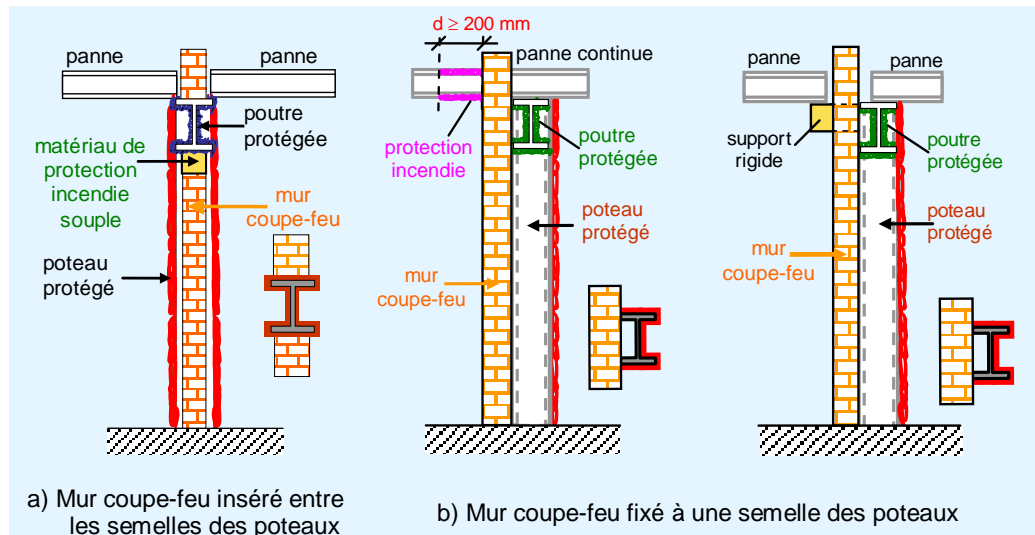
Détail de conception à proximité de murs coupe-feu parallèles aux portiques en acier
